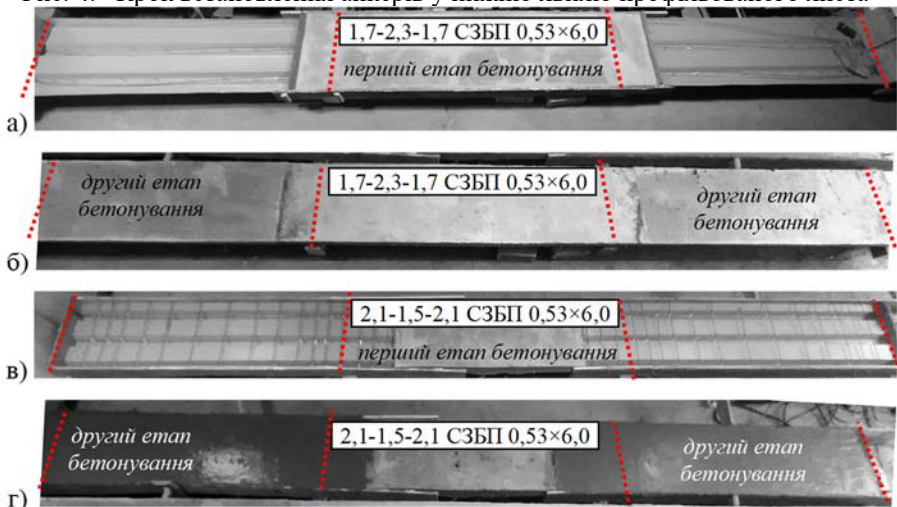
Загальний вигляд зразків сталобетонних плит на етапах бетонування
